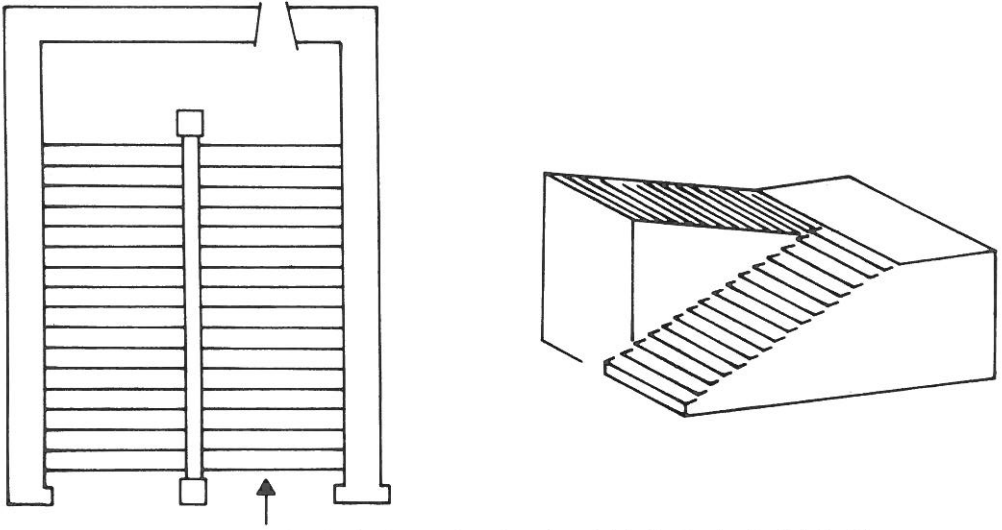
Planta y alzado de la escalera interior del Palacio de Grajal de Campos (León).
